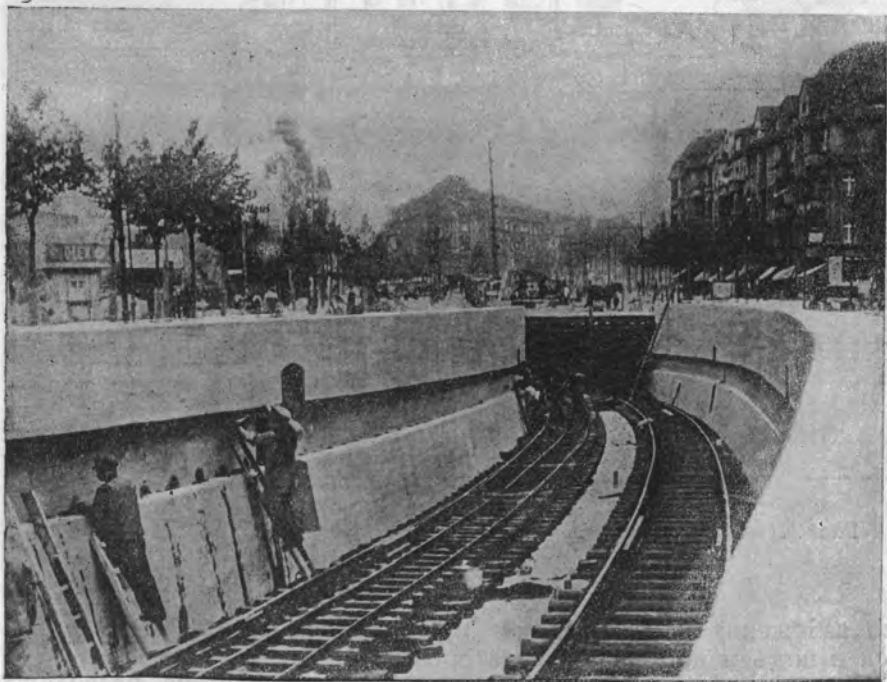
Распалубка железобетонной конструкции рамы Берлинского метрополитена.
